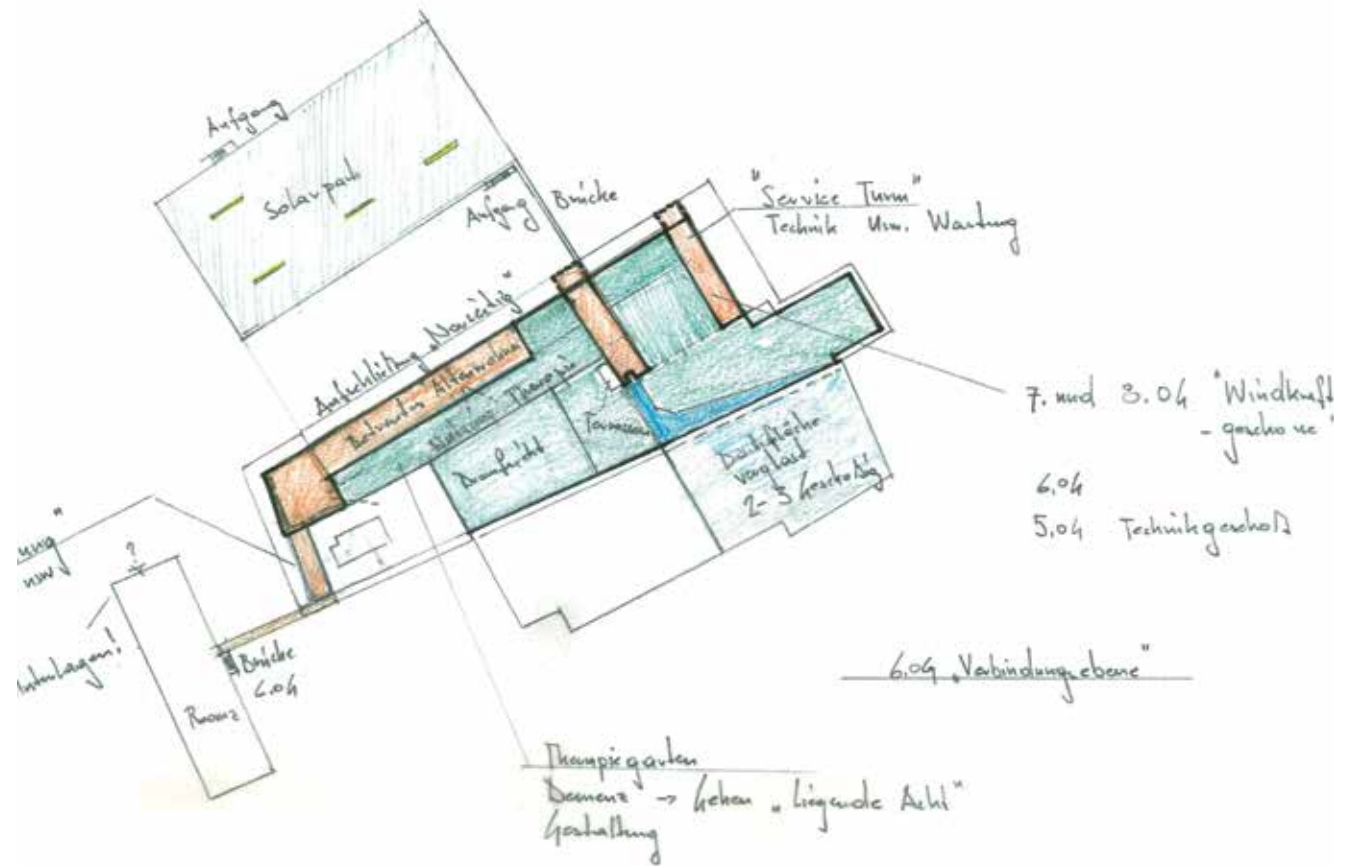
Studie betreutes Wohnen: Übergang Dach Halle „A“?
